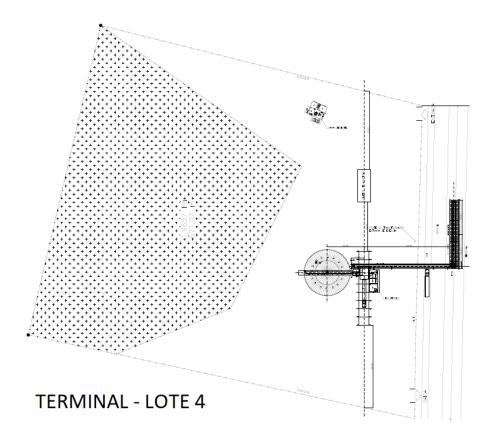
Layout do Lote 4 do terminal de Porto Franco/MA.
